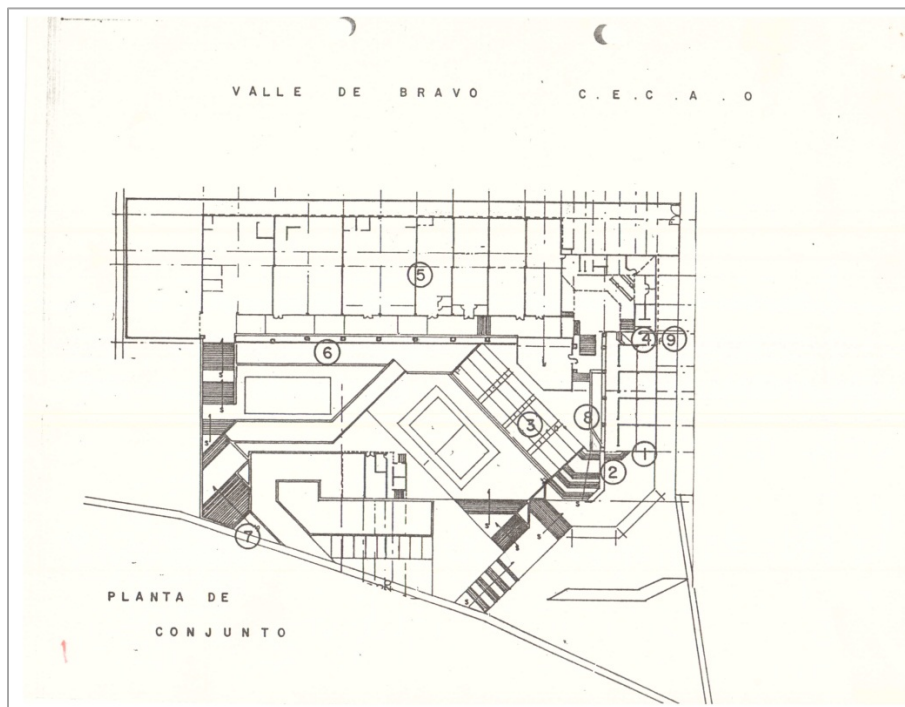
Planta de Conjunto CECAO Valle De Bravo, México
